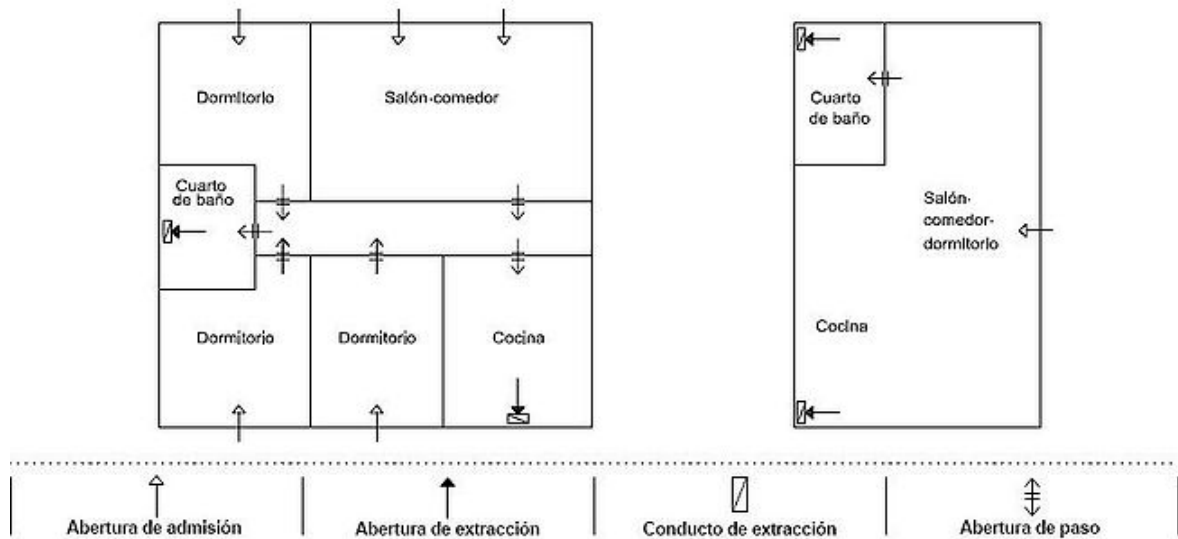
Ejemplo de ventilación en el interior de las viviendas
